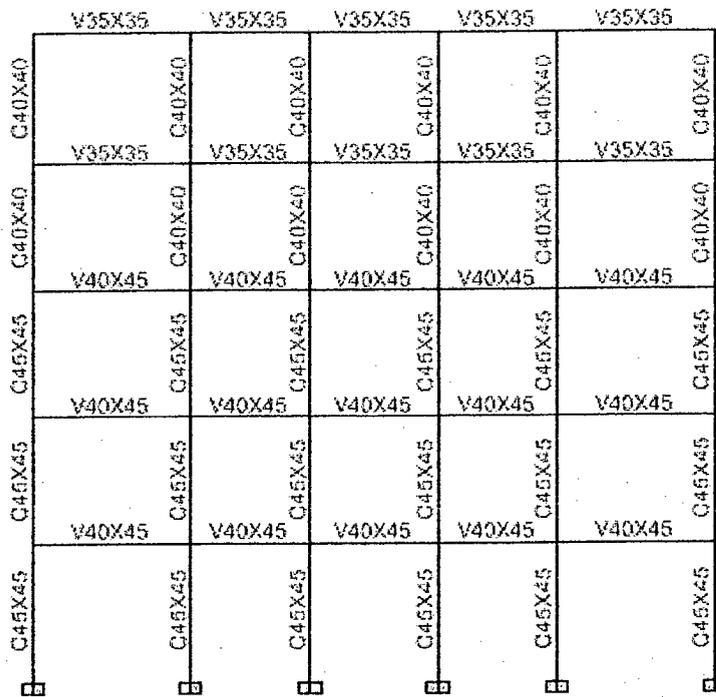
ELEVACIÓN A (Secciones de columnas y vigas)
